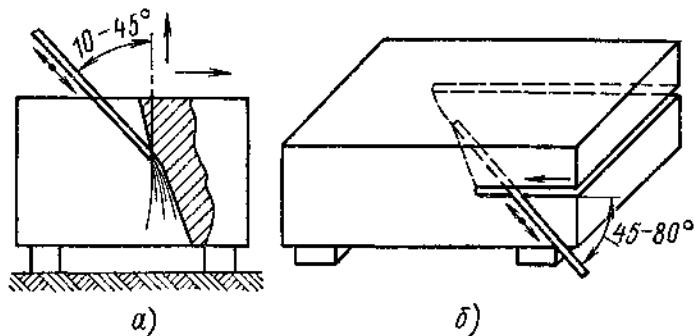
Резка бетона и железобетона толщиной более 200—300 мм:
